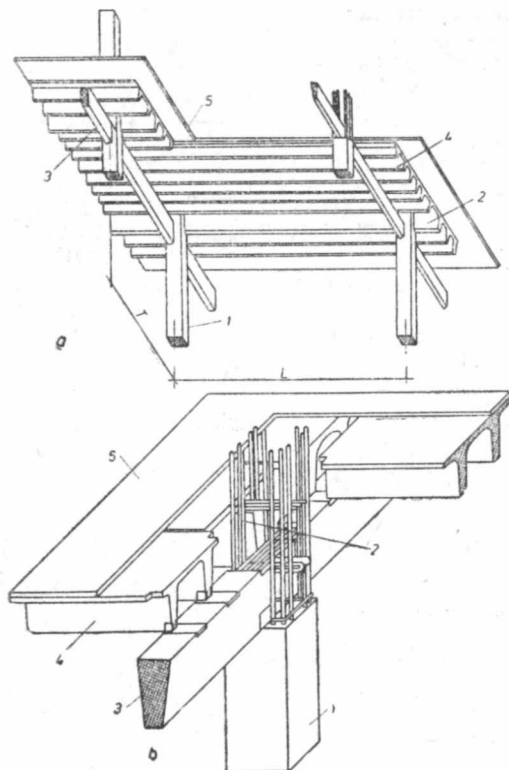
Elementele structurii parțial prefabricate pentru hale industriale etajate :
